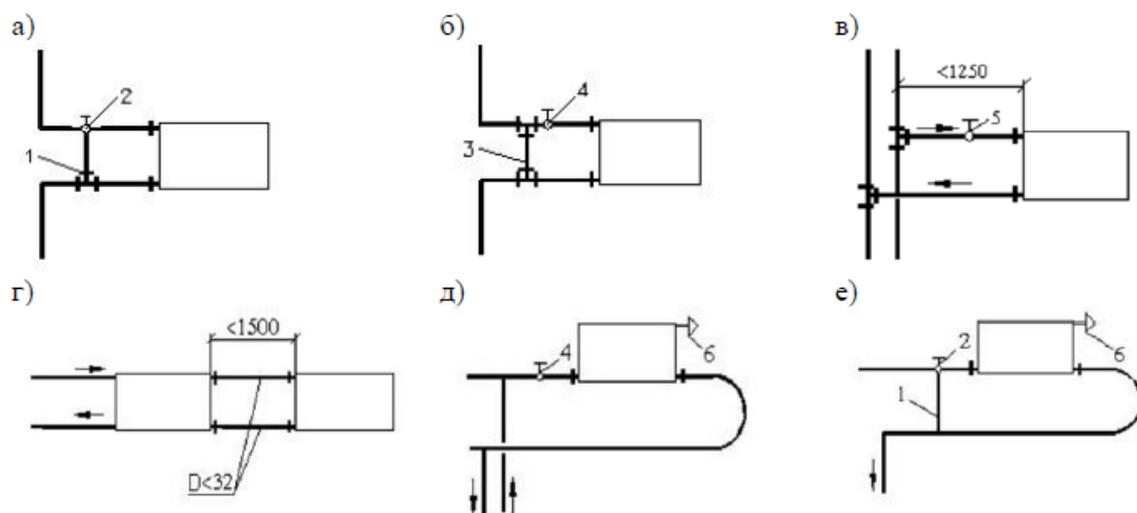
Присоединение теплопроводов к отопительным приборам вертикальных систем отопления
